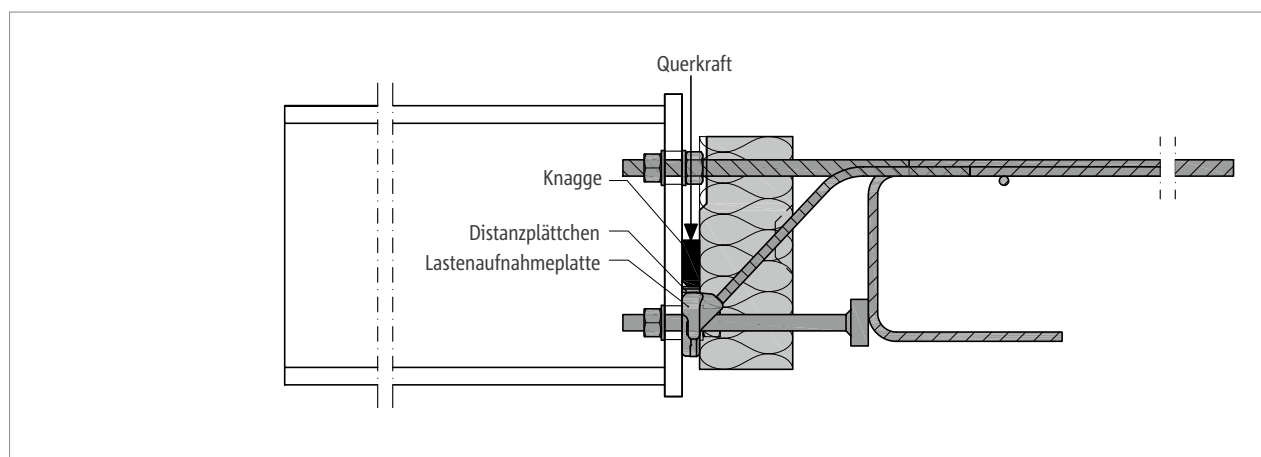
Schöck Isokorb® T Typ SKP: Bauseitige Knagge zur Übertragung der Querkraft
